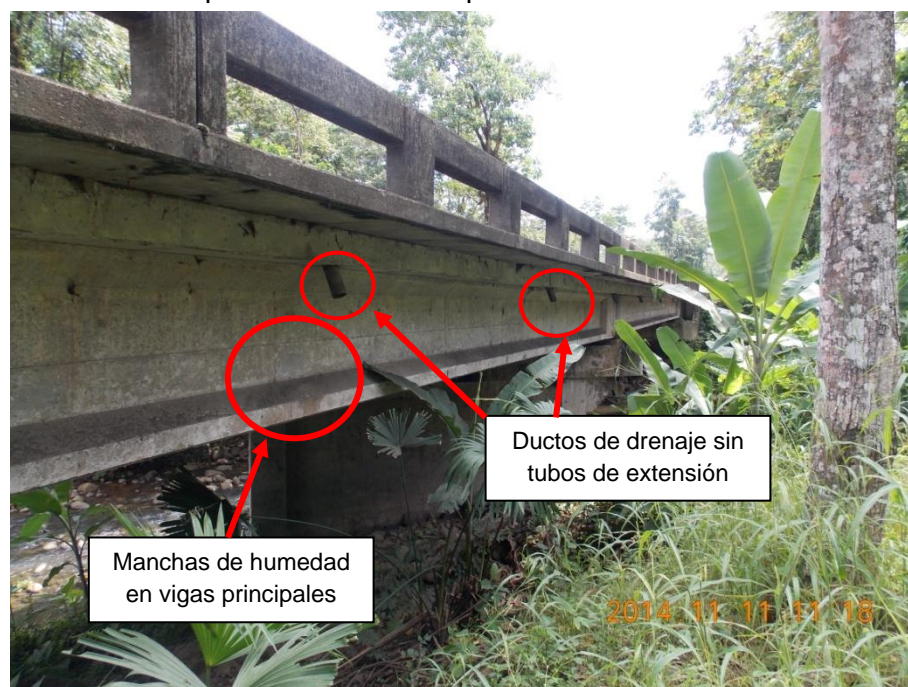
Ductos de drenaje sin tubos de extensión que descargan directamente sobre las vigas principales.
